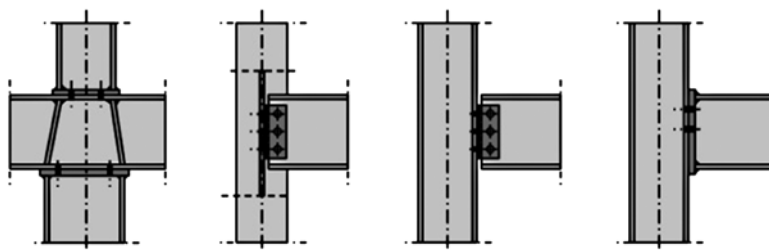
a. Collegamenti trave-pilastro di strutture in acciaio tipiche dei nodi di strutture pendolari.
